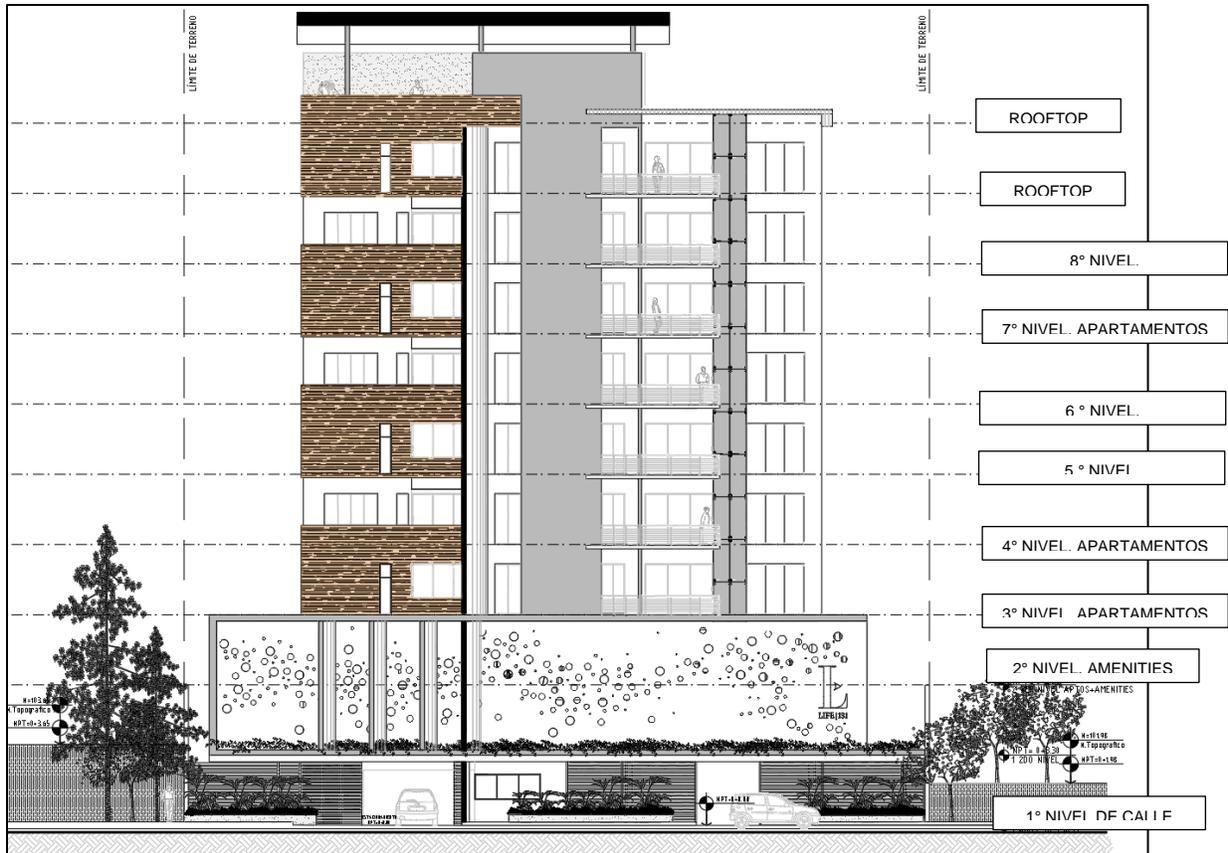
Elevación de fachada principal. FUENTE: *MR ARQUITECTURA CONCEPTO
